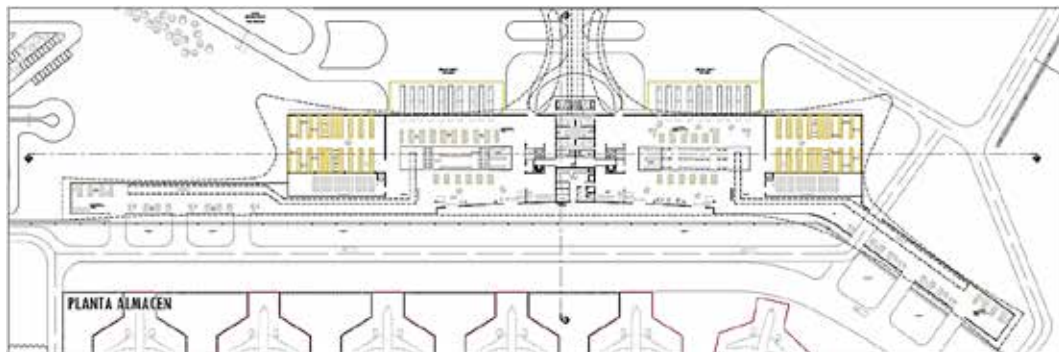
Planta baja edificación de almacenamiento. Fuente: Sosa (2020)
